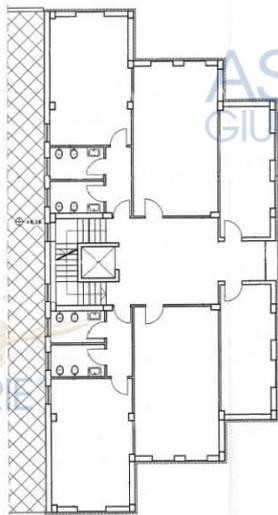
Planimetria STATO DI FATTO piano tipo zona uffici
